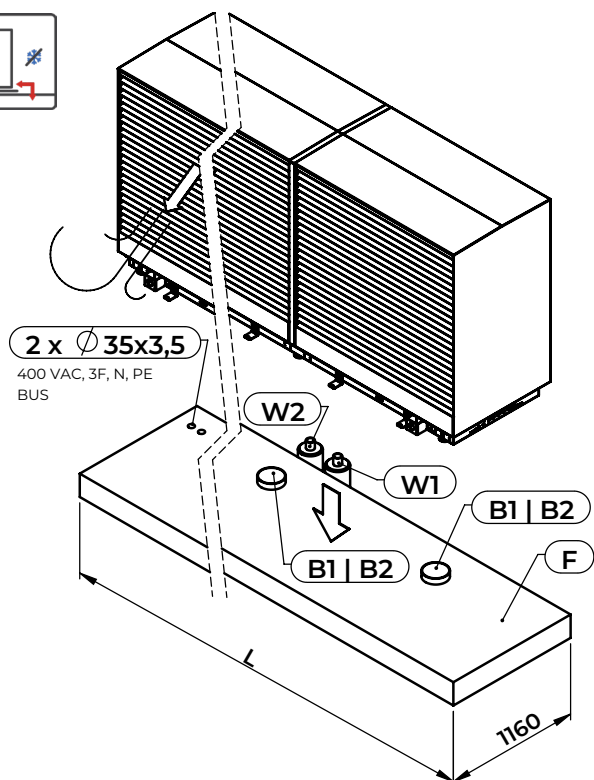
AirCalor-K K-70/-105/-140-fondation
